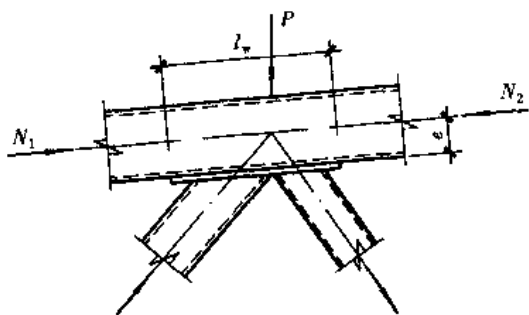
有外荷载时垫板连接焊缝计算简图
